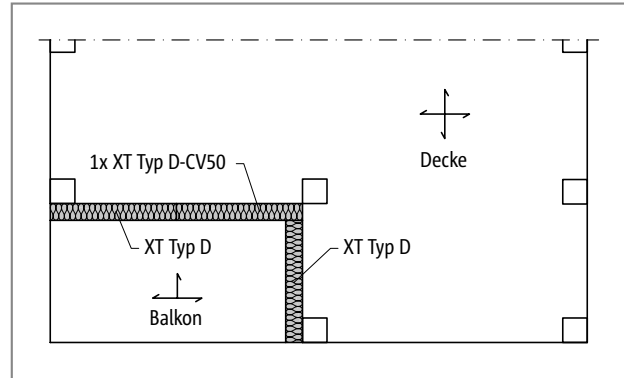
Schöck Isokorb® XT Typ D: Einsatz in Flachdecken
